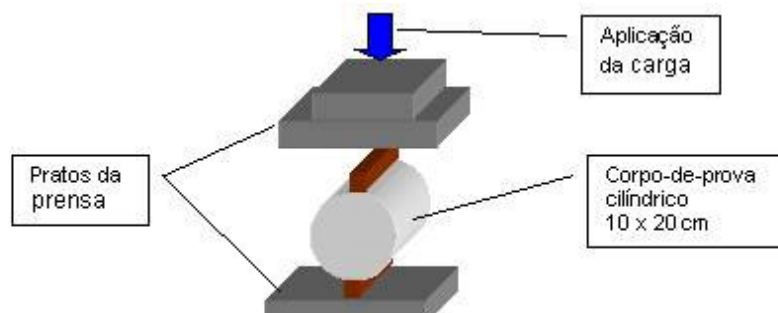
Esquema simplificado do ensaio de tração por compressão diametral.
